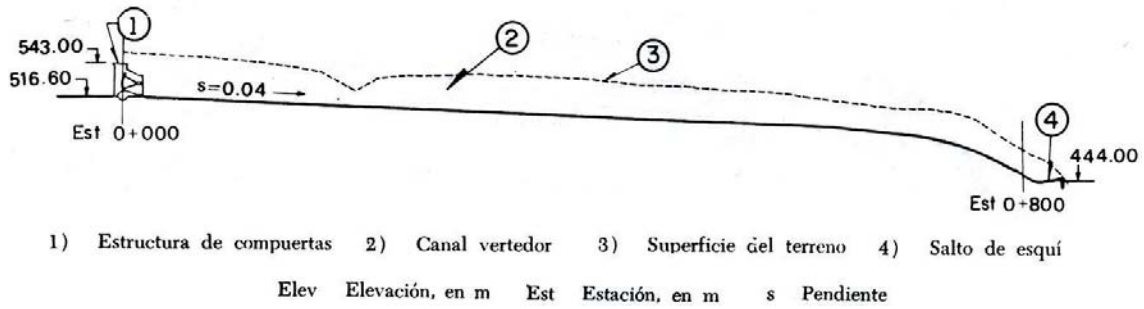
(a). Sección longitudinal del vertedor. Presa La Angostura.
